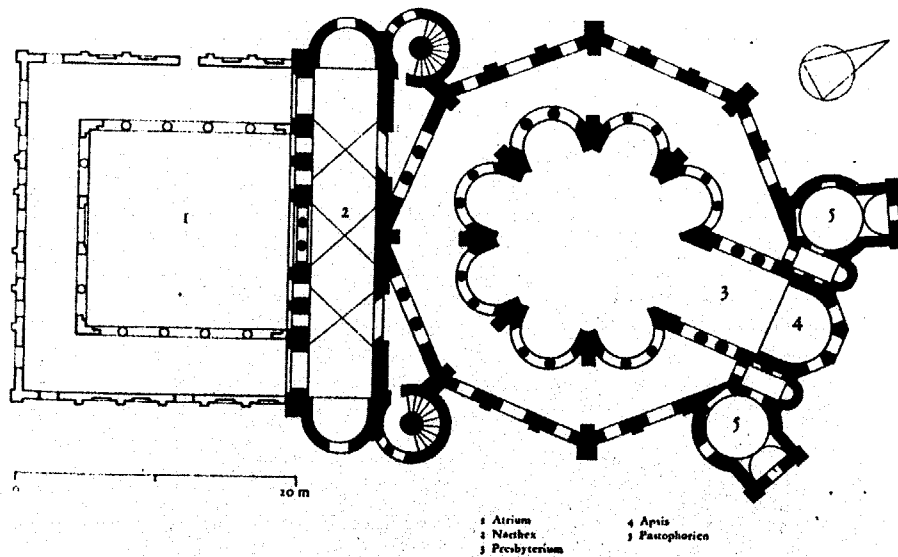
： サン・ヴィターレ聖堂1階平面図 (after C. Mango)
